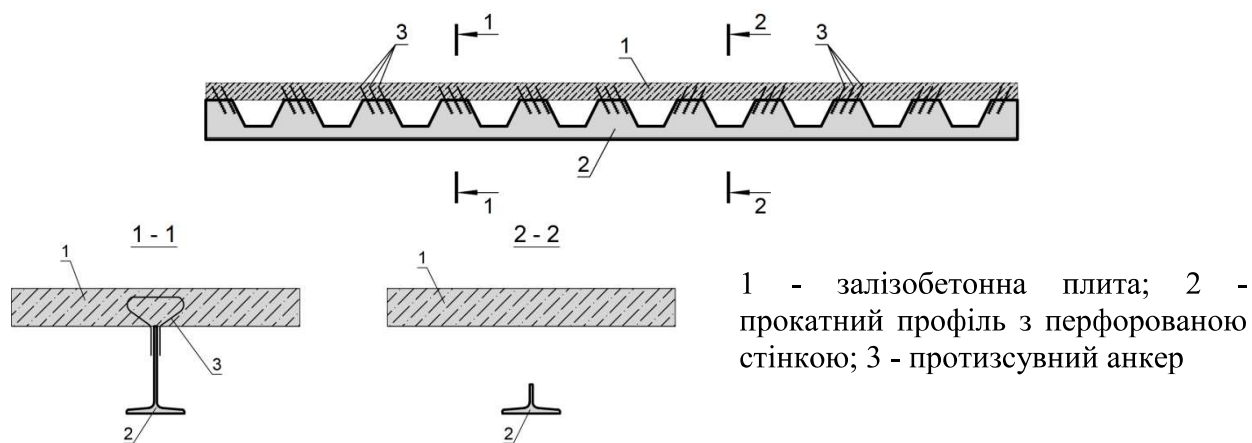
Сталезалізобетонна модифікована балка з перфорованою стінкою
